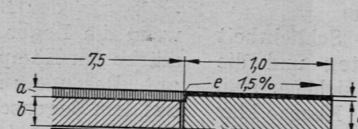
Betonunterbau und Betonrandstreifen mit Gußasphaltbelag (heute übliche Bauart).
